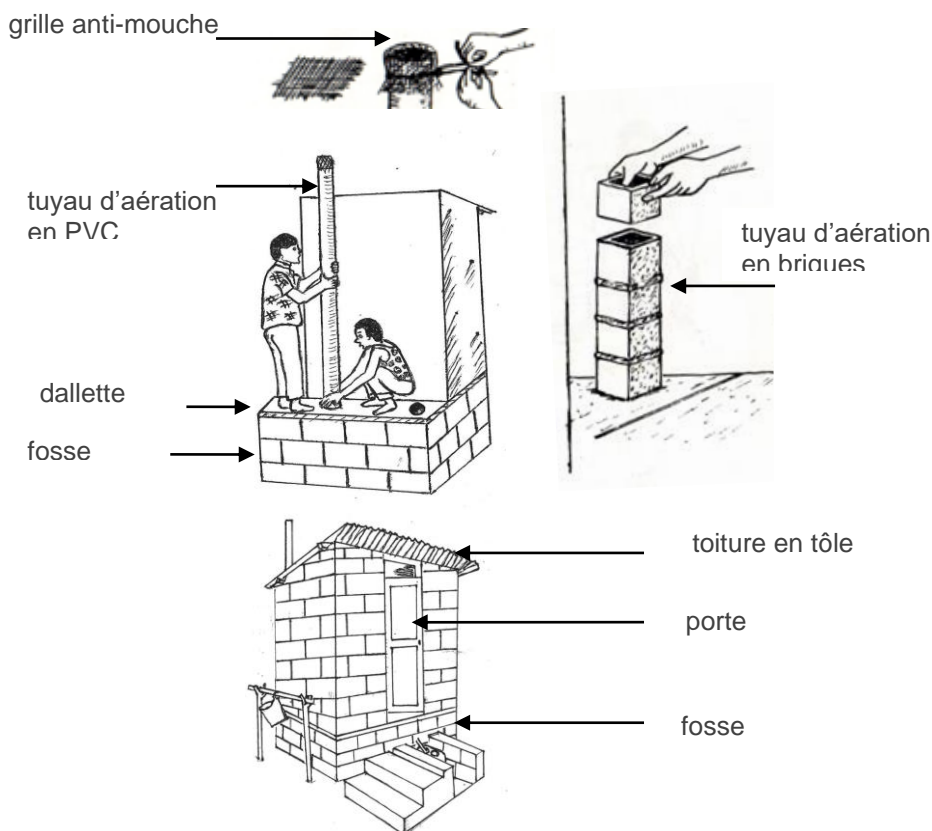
Pose des accessoires et vue générale d'une latrine Ecosan
